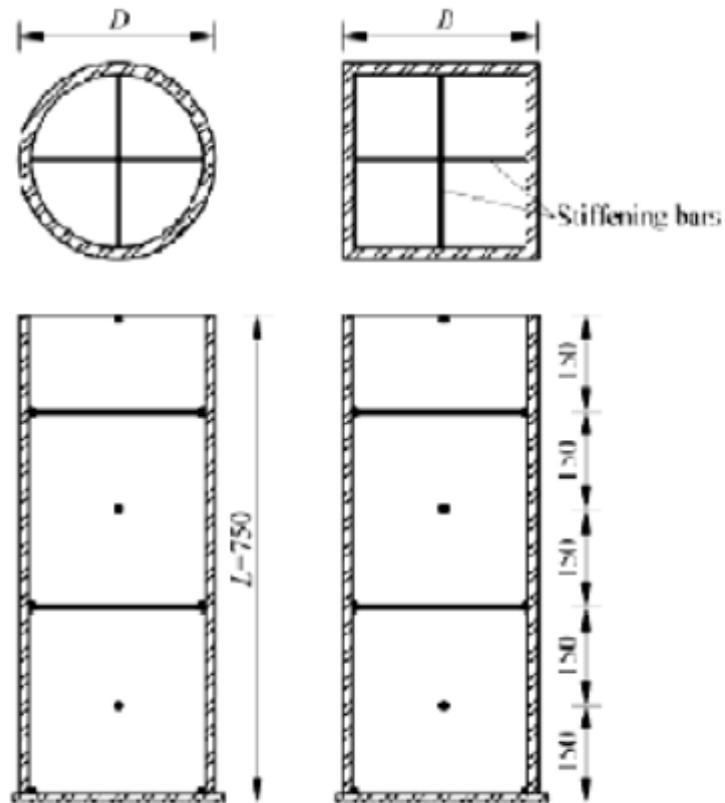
Détail des poteaux mixtes de section à barres croisées[31].
